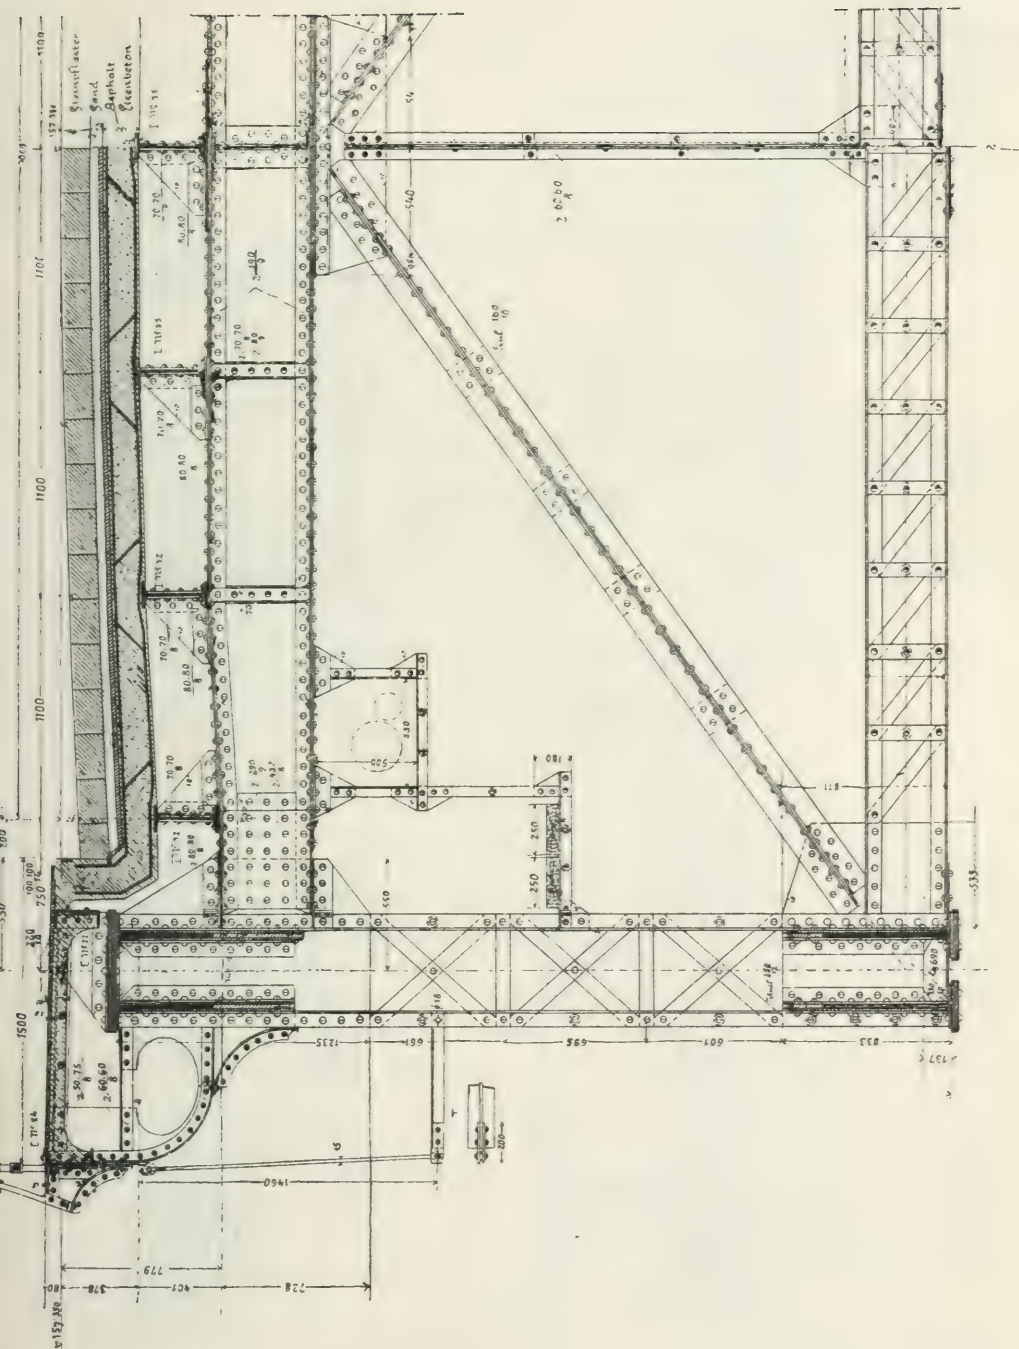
Straßenbrücke mit oben liegender Fahrbahn, (Nach Plänen des österreichischen Arbeitsministeriums.)
